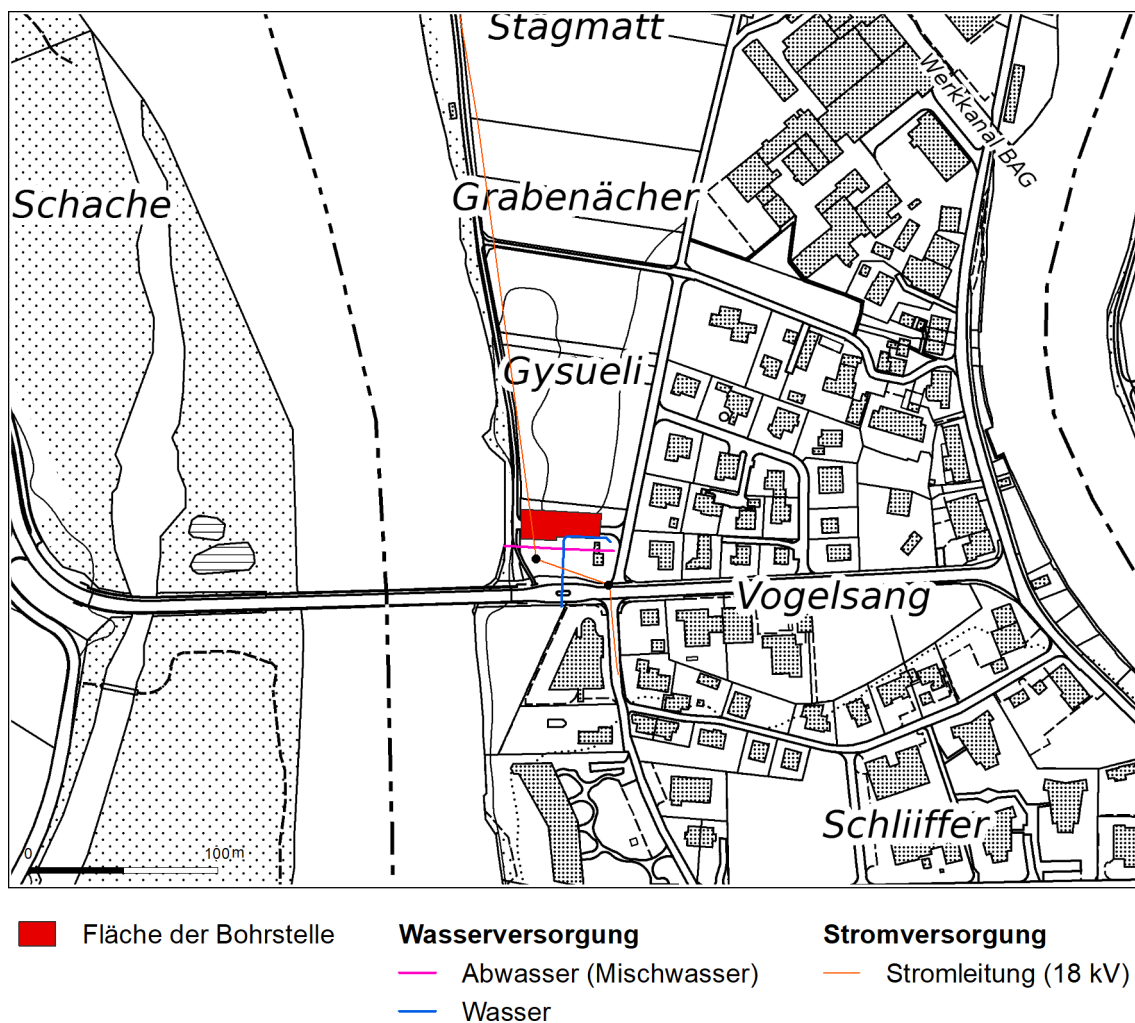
Situationsplan der QBO Gebenstorf-Vogelsang mit Leitungsführung im Bereich der Bohrstelle.
